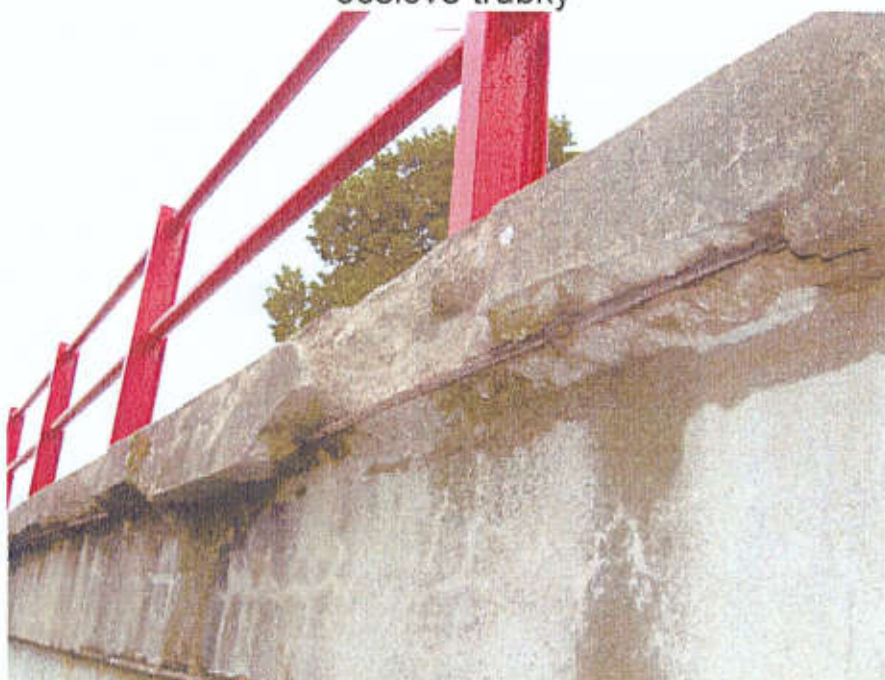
Pohled na pravou stranu mostu – degradace betonu říms
